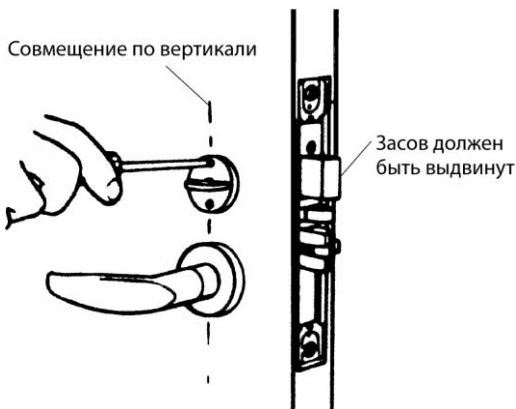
Установка поворотной рукоятки (С разрешения компании Schlage Lock Company)
